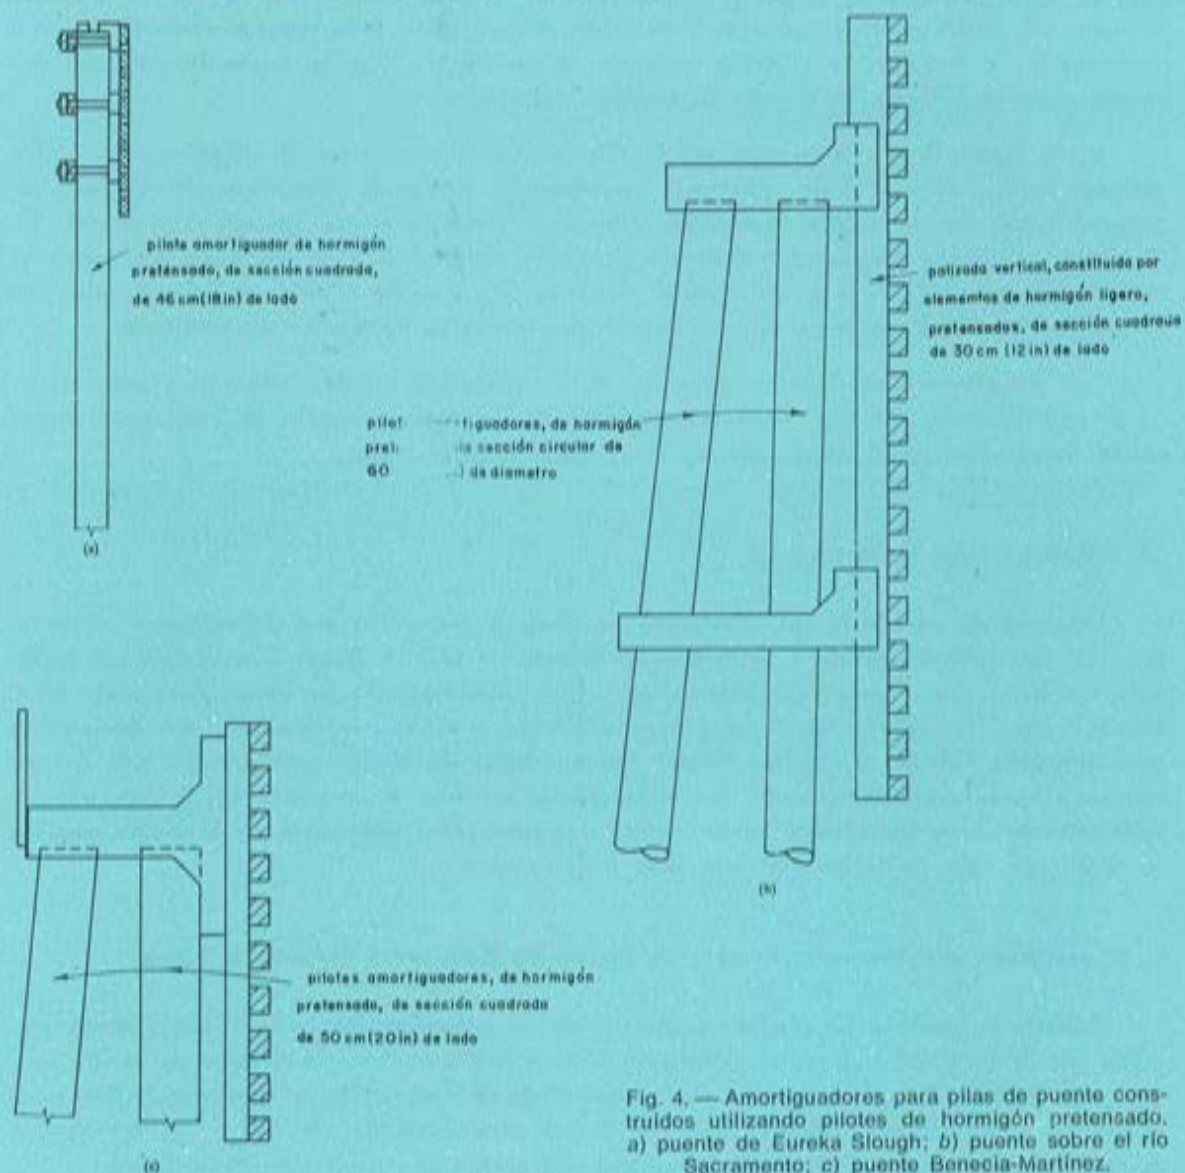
Amortiguadores para pilas de puente construidos utilizando pilotes de hormigón pretensado. a) puente de Eureka Slough; b) puente sobre el río Sacramento; c) puente Benecia-Martínez.
